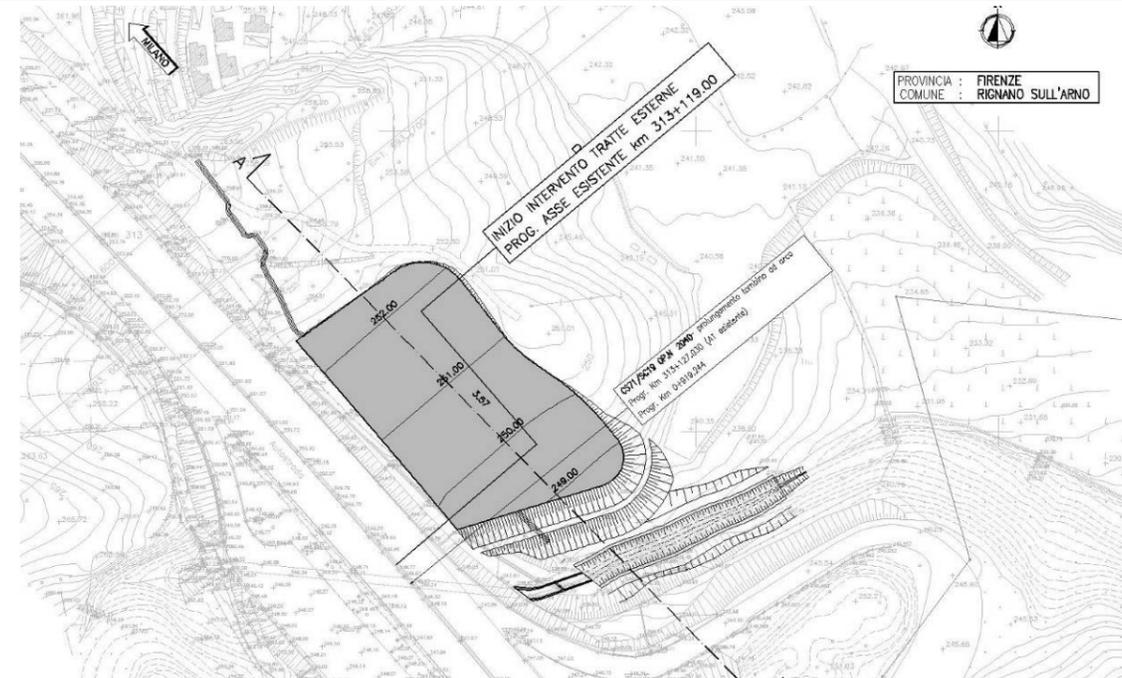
Zona Adp Rignano: rimodellamento del progetto approvato dalla Cds
